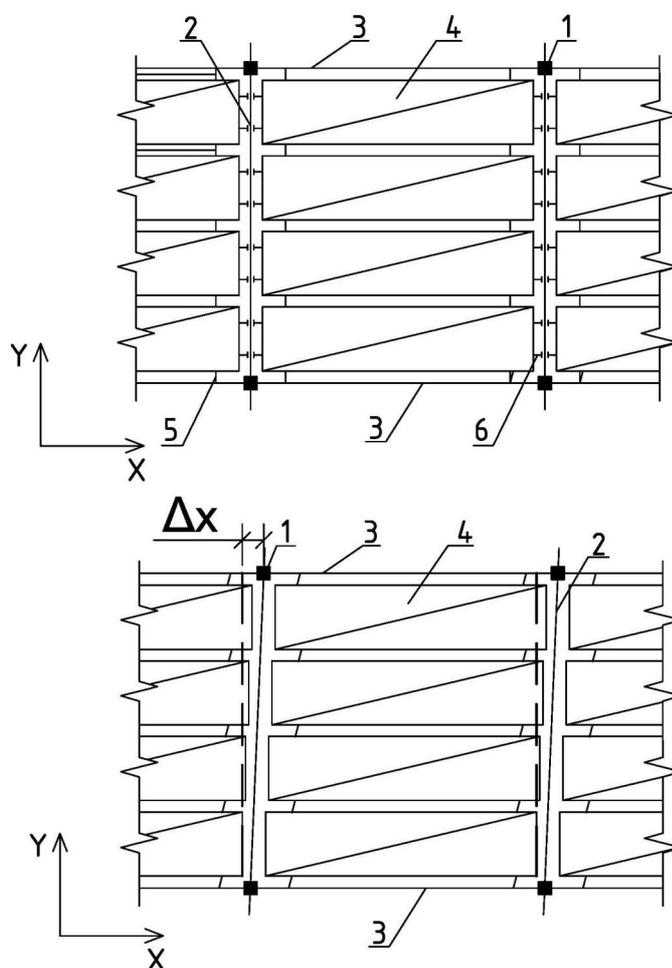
Связи сдвига между многопустотными плитами перекрытий безопалубочного формования
